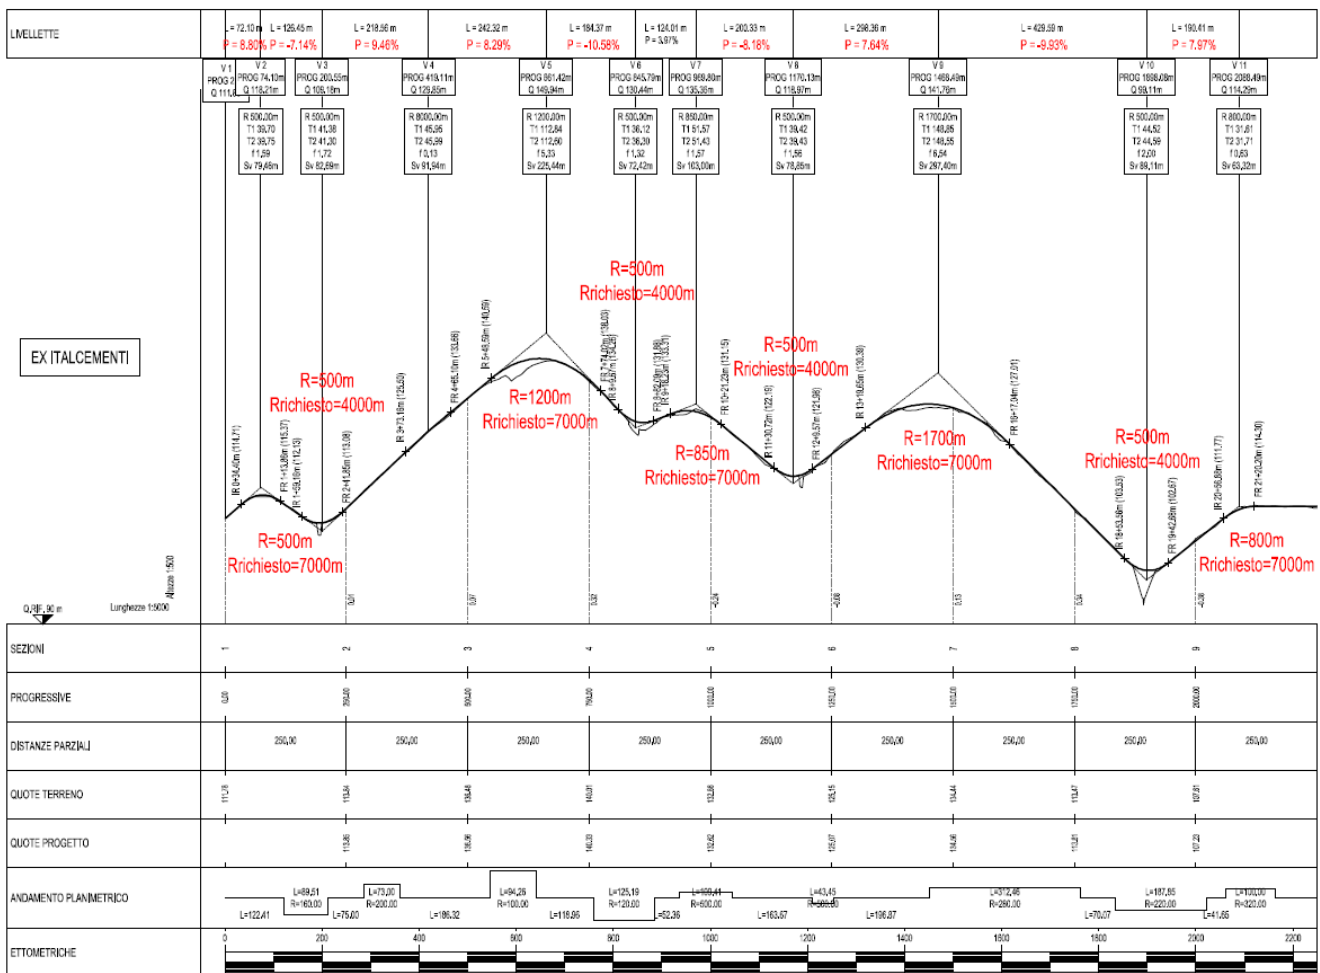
PROFILO STRADA PRIVATA (ULTIMI 2,2 KM)
